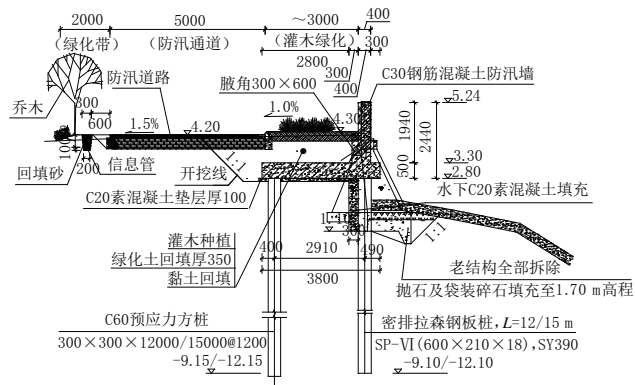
重建L形高桩承台典型断面(尺寸单位:mm;高程单位:m)
